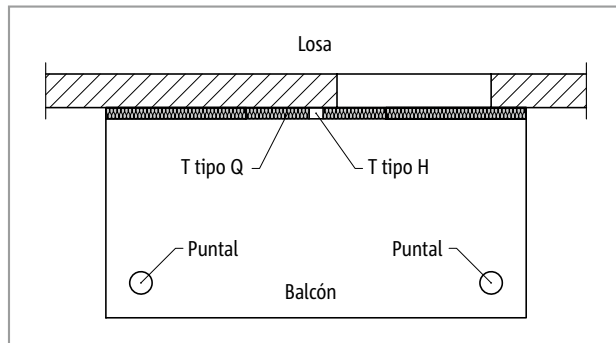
Schöck Isokorb® T tipo Q: Balcón apoyado en puntales
